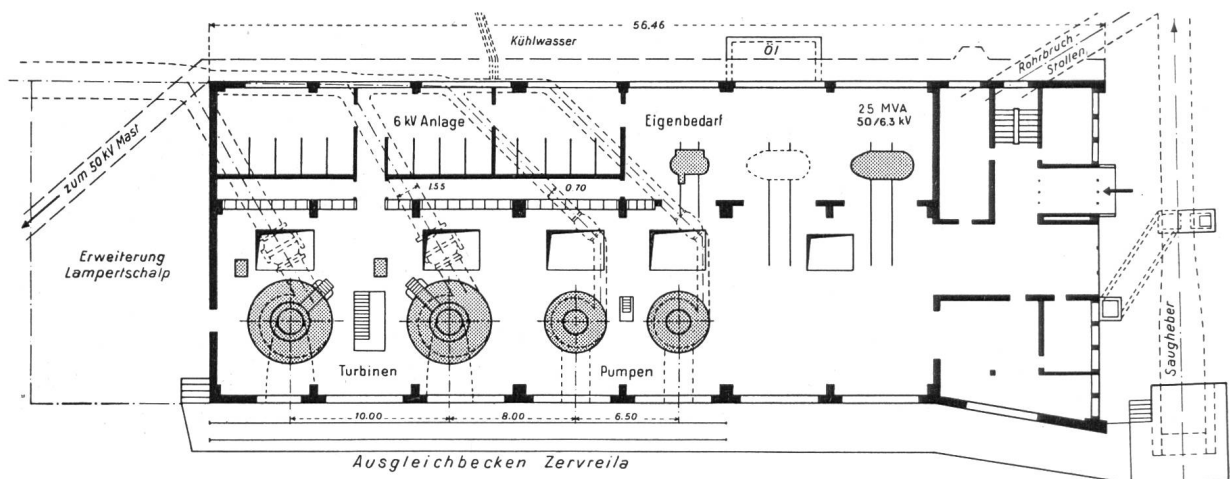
Grundrißdisposition 1:500 des Maschinenhauses Zervreila
